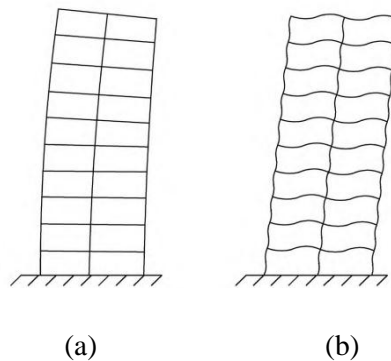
Le mouvement latéral dans la trame rigide: (a) Déformation causée par l'encastrement, (b) Déformation causée par la flexion des poteaux et poutres
